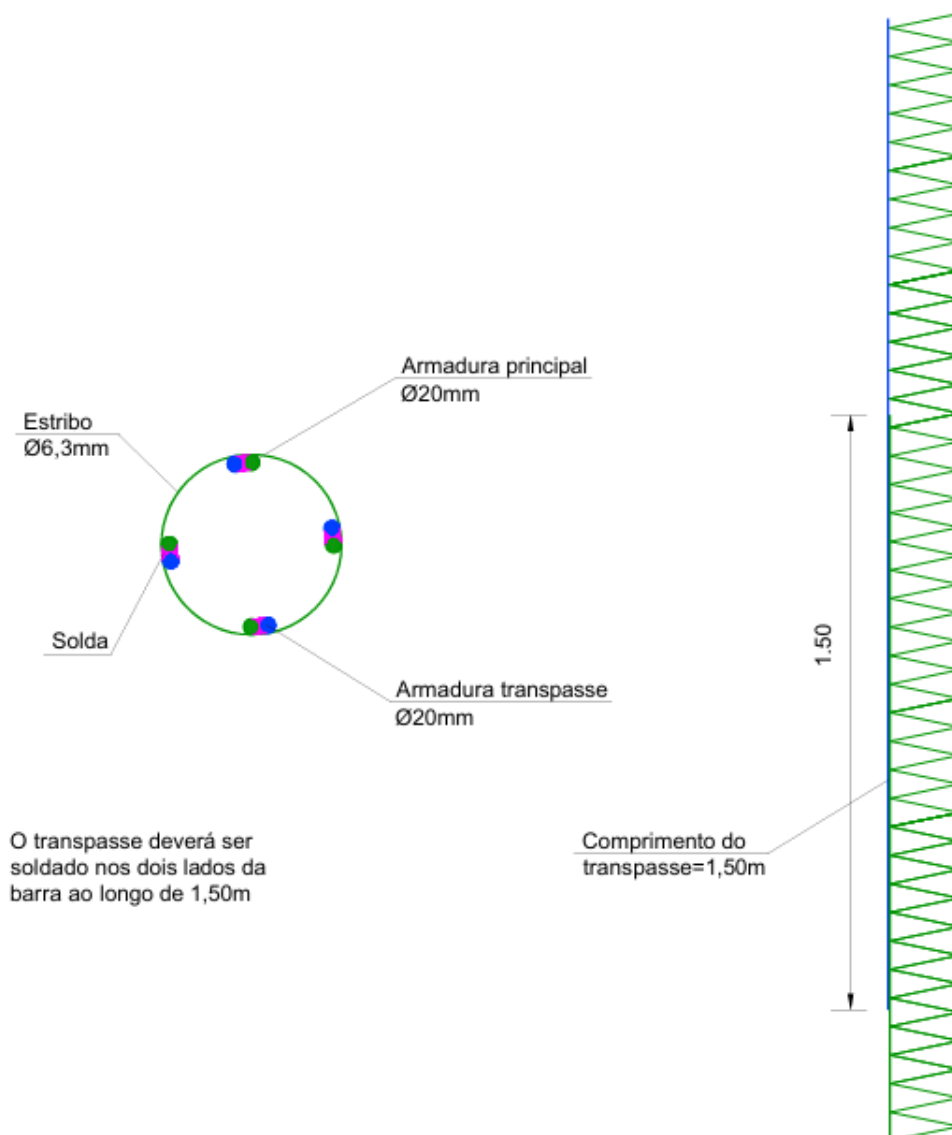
Transpasse Armaduras Estaca Raiz
